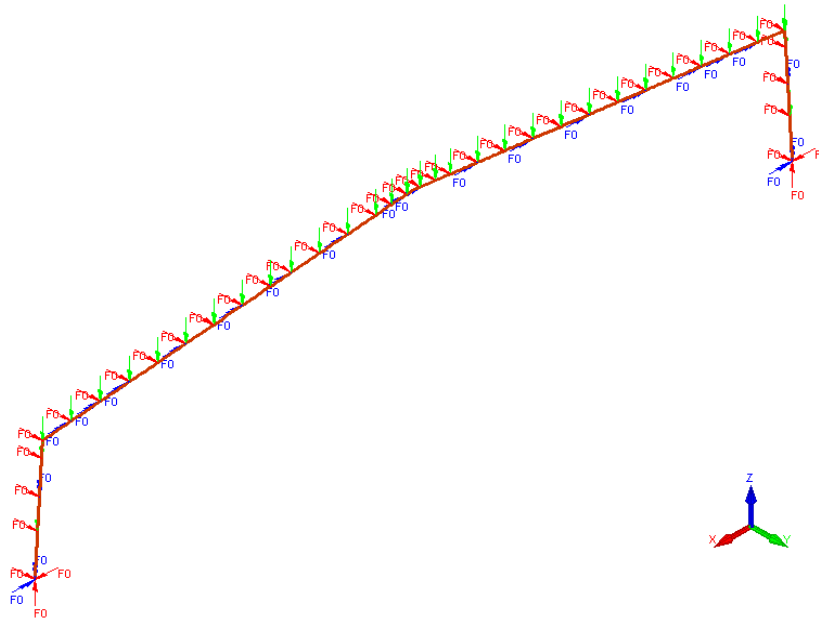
Carregamento e restrições aplicados na estrutura porticada.
